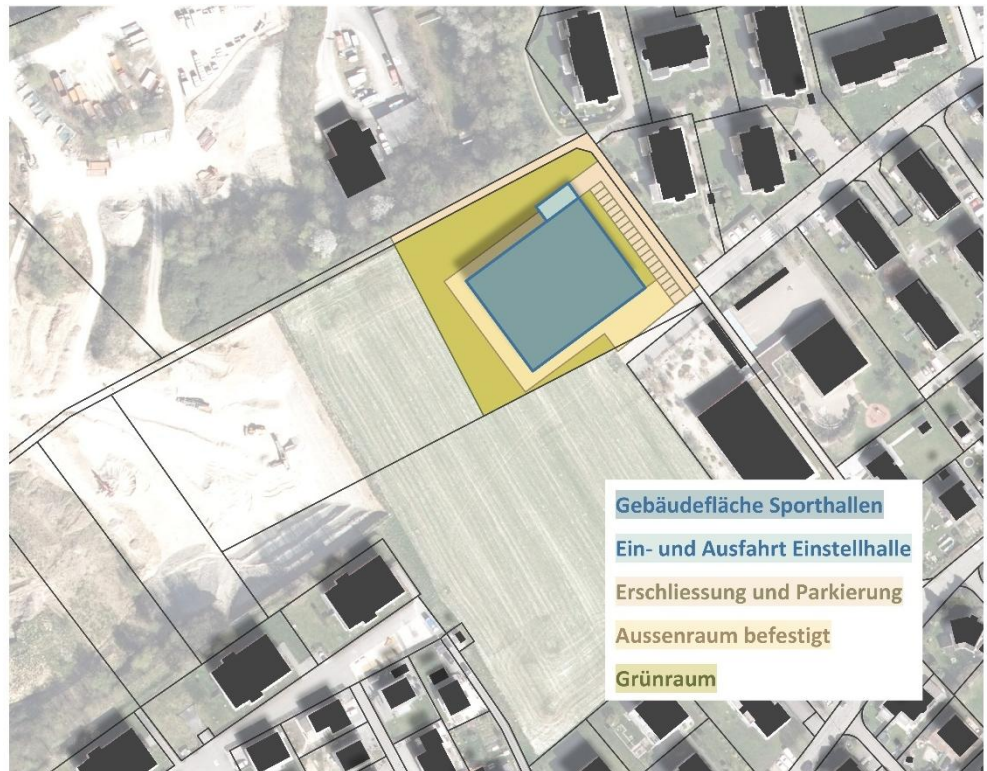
Schematische Annäherung / Darstellung der Umsetzung einer Dreifachturnhalle
